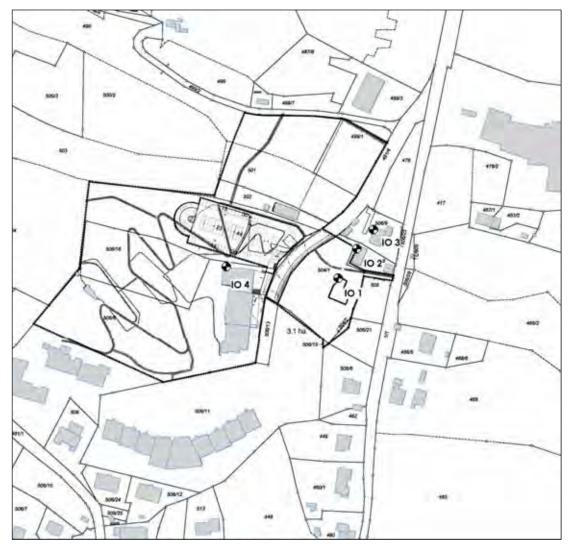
Lageplan mit Darstellung der Immissionsorte (IO)
